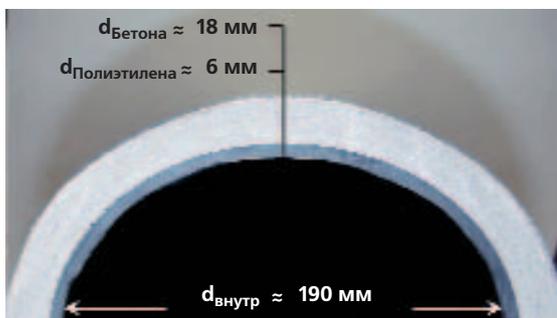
Поперечное сечение стенки трубы с шестью слоями текстильного армирования (d_i приблизительно 190 мм).
